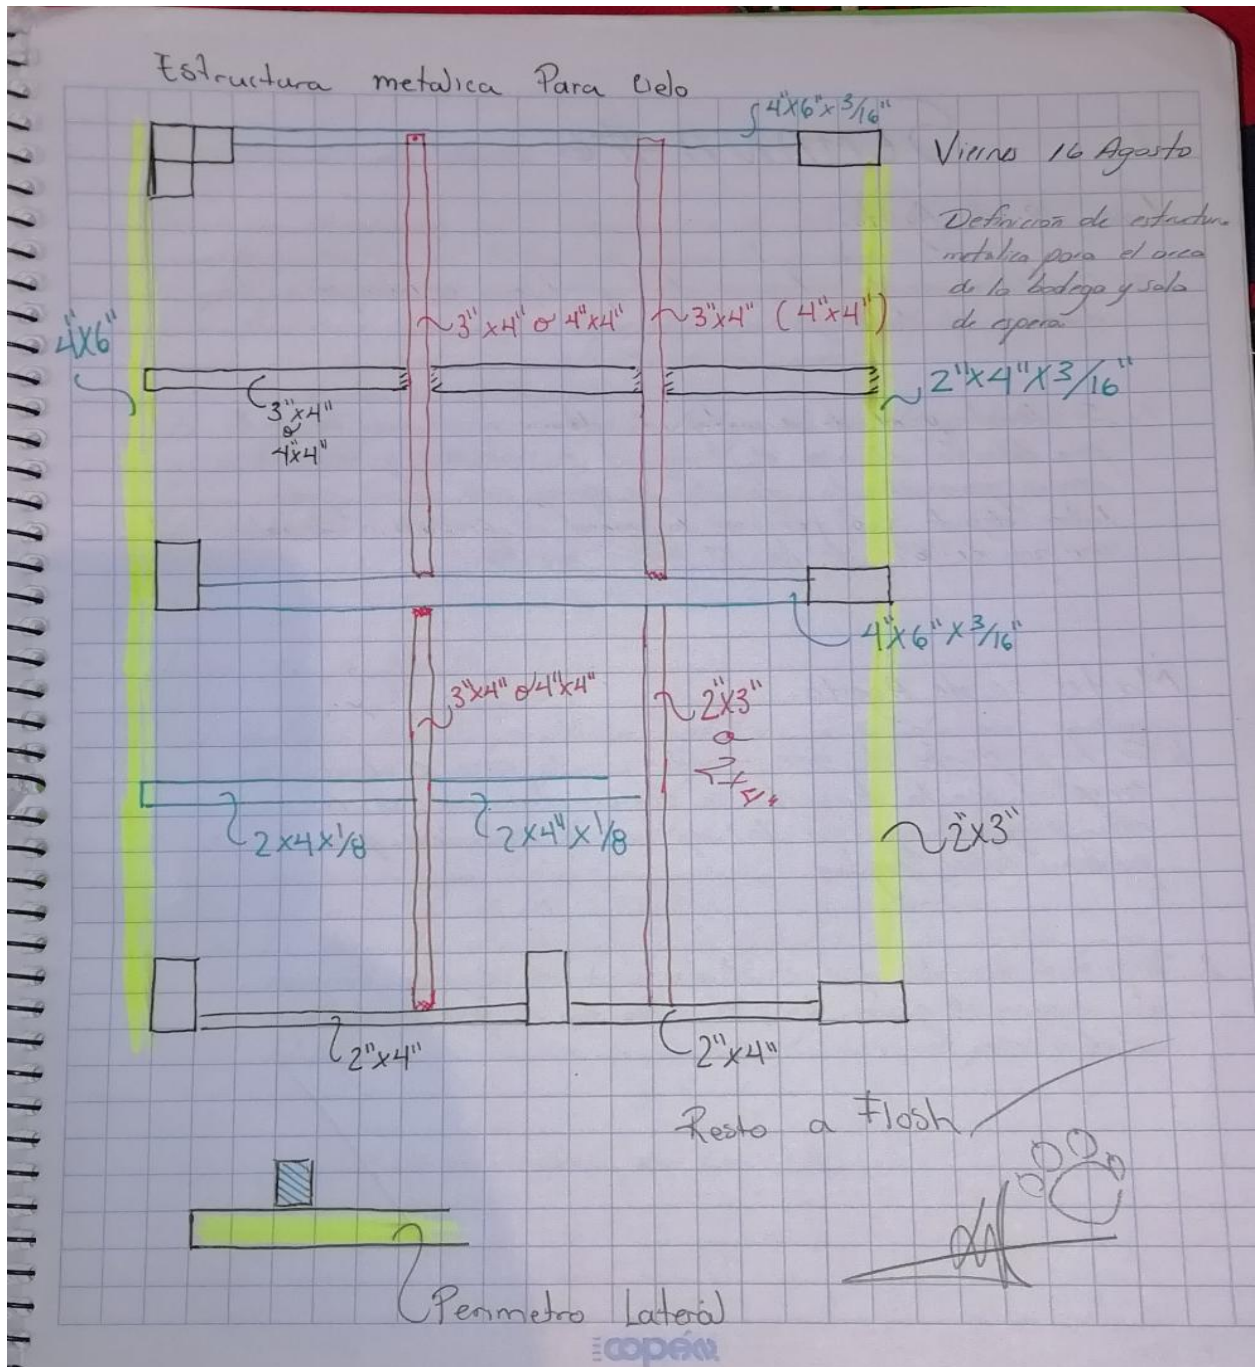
DETALLE DE ESTRUCTURA METÁLICA PARA CIELO FALSO.
